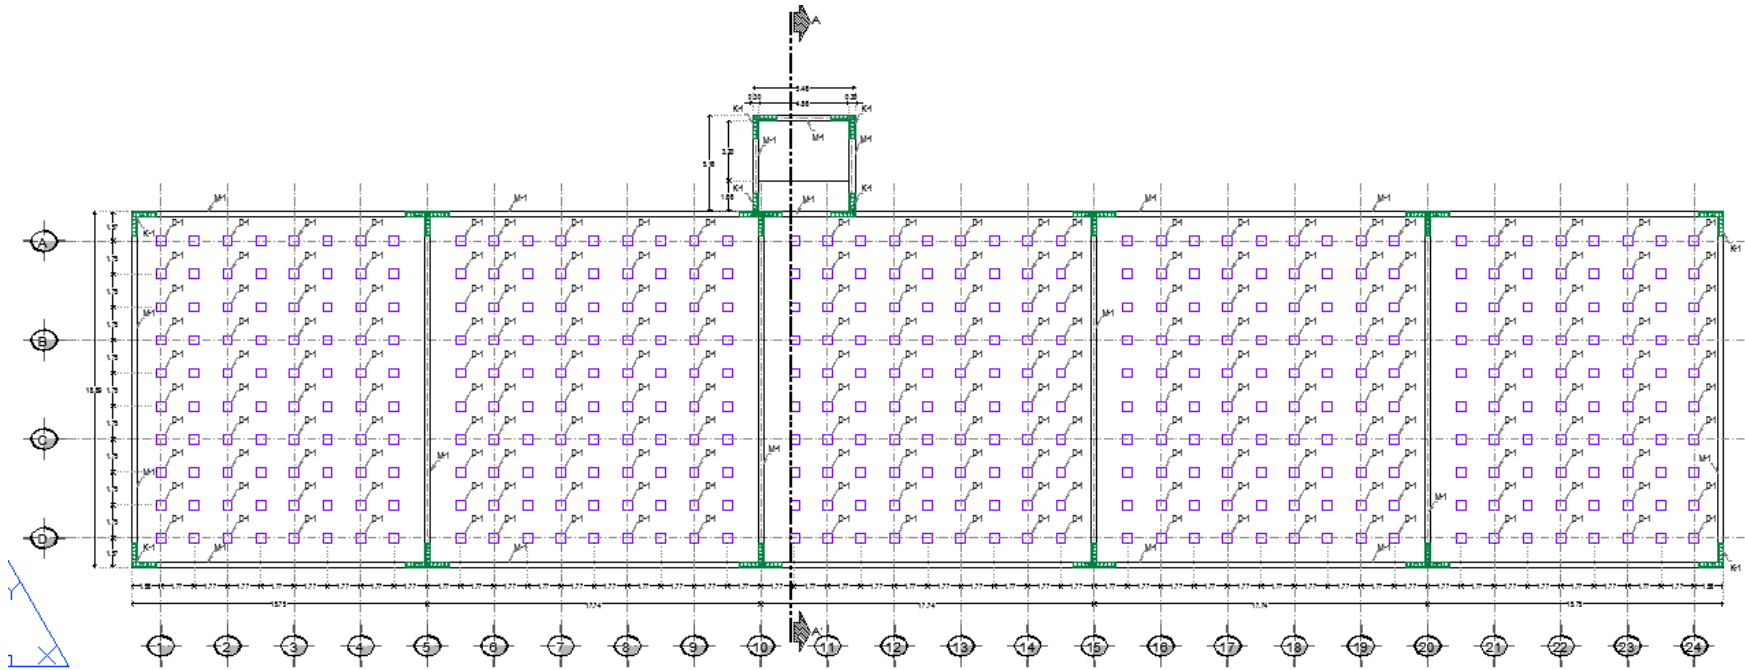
Arreglo de cimentación para torre de enfriamiento (Vista en planta)
